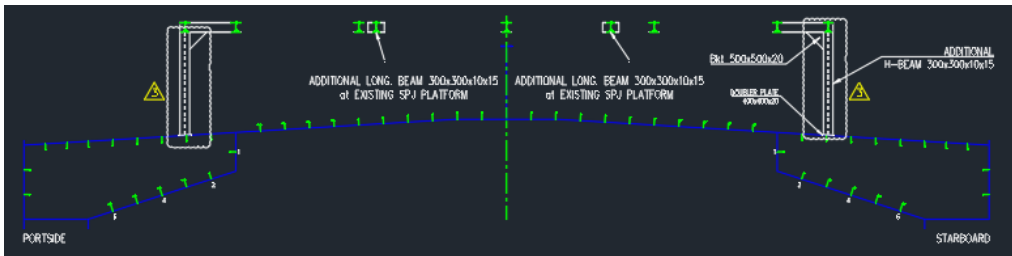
Elevation Rows B, B' (section membujur di CL+4590)
